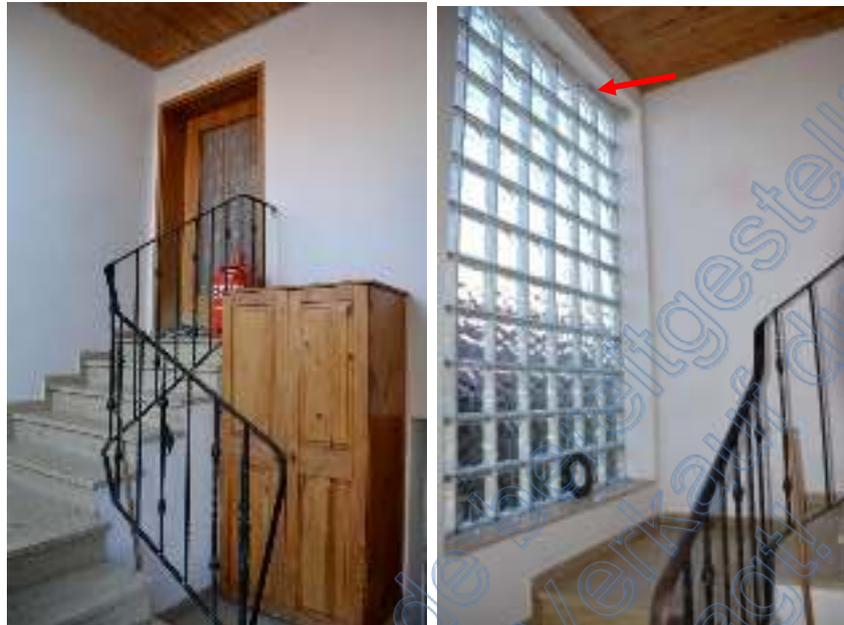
,b: Treppenhaus, Glasbausteine, Schimmelpilzbefall (Pfeil)
